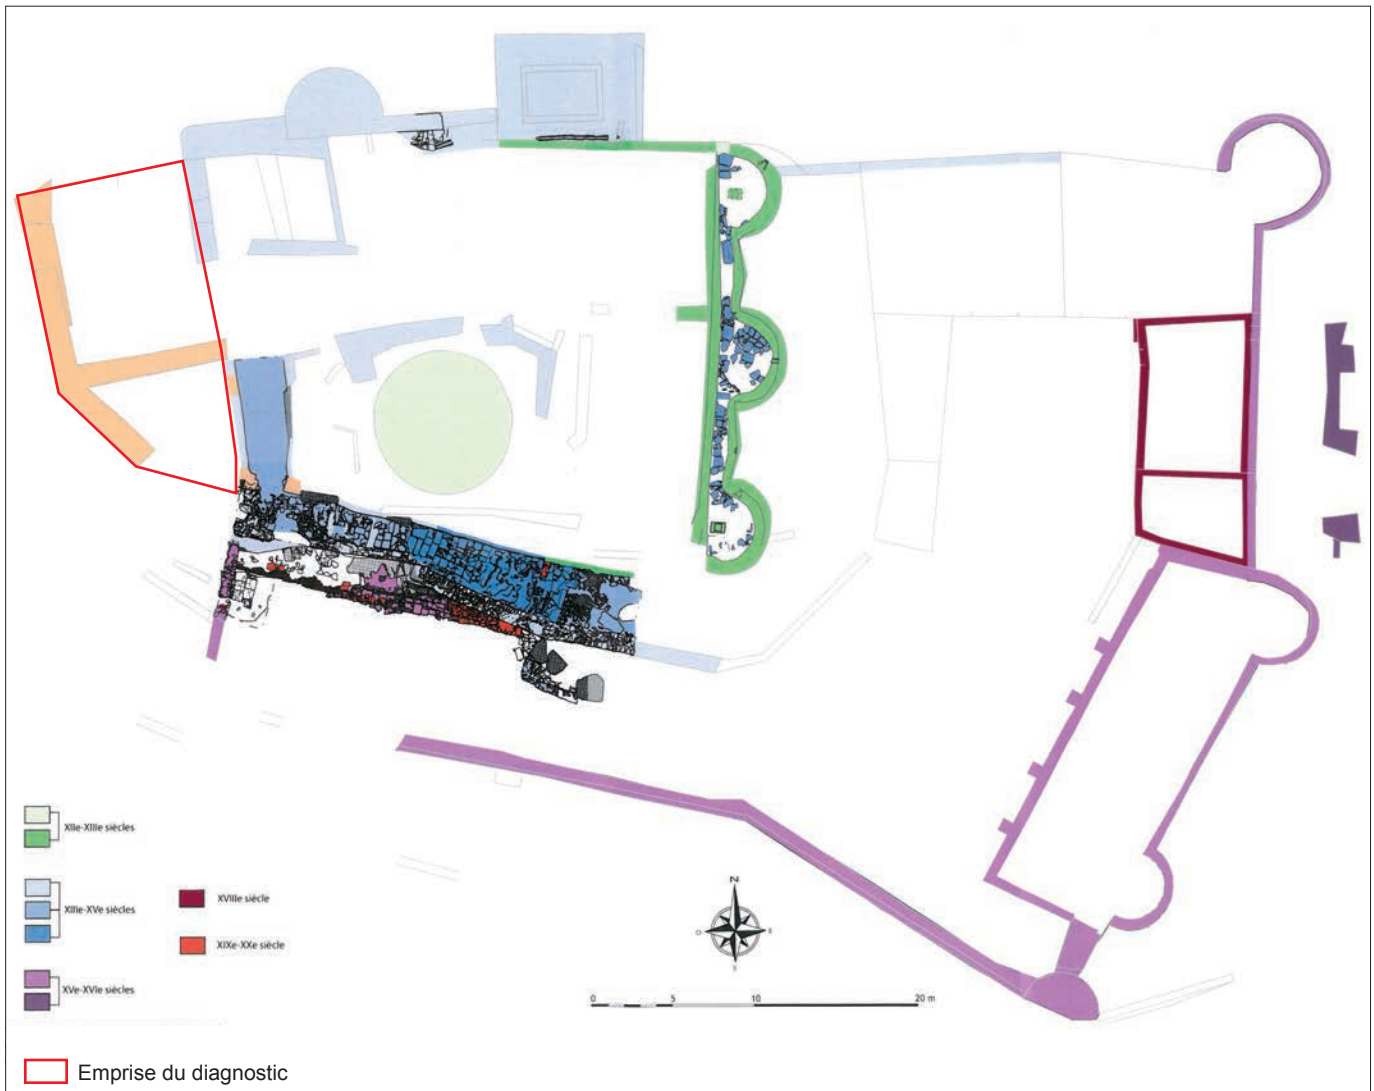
Plan phasé des élévations du château issu du rapport de M. Navetat 2014 (© Géoval, Hadès)
